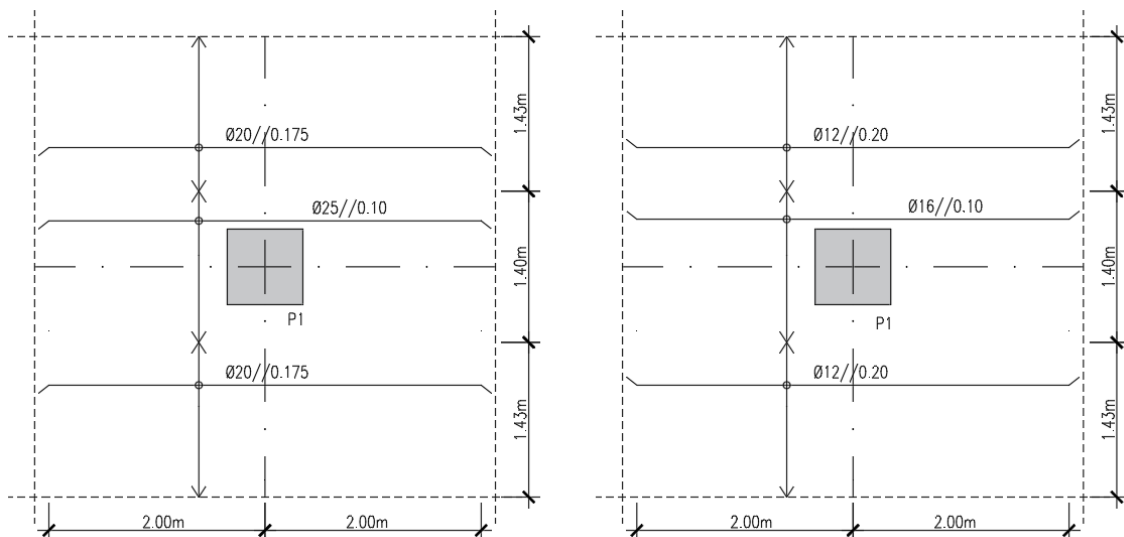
Pormenorização das armaduras de flexão na faixa central. Esquerda: armaduras superiores; Direita: armaduras inferiores.
